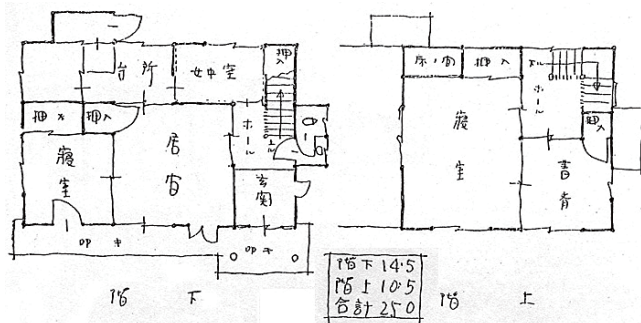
『住宅組合法解釈』のNo.2 豊島住宅組合の図
